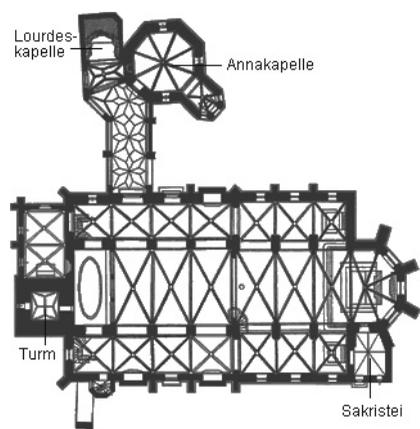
Grundriss der Pfarrkirche Altenmarkt mit dem nördlich gelegenen Karner und dem später angelegtem Verbindungsgang zur Kirche.
